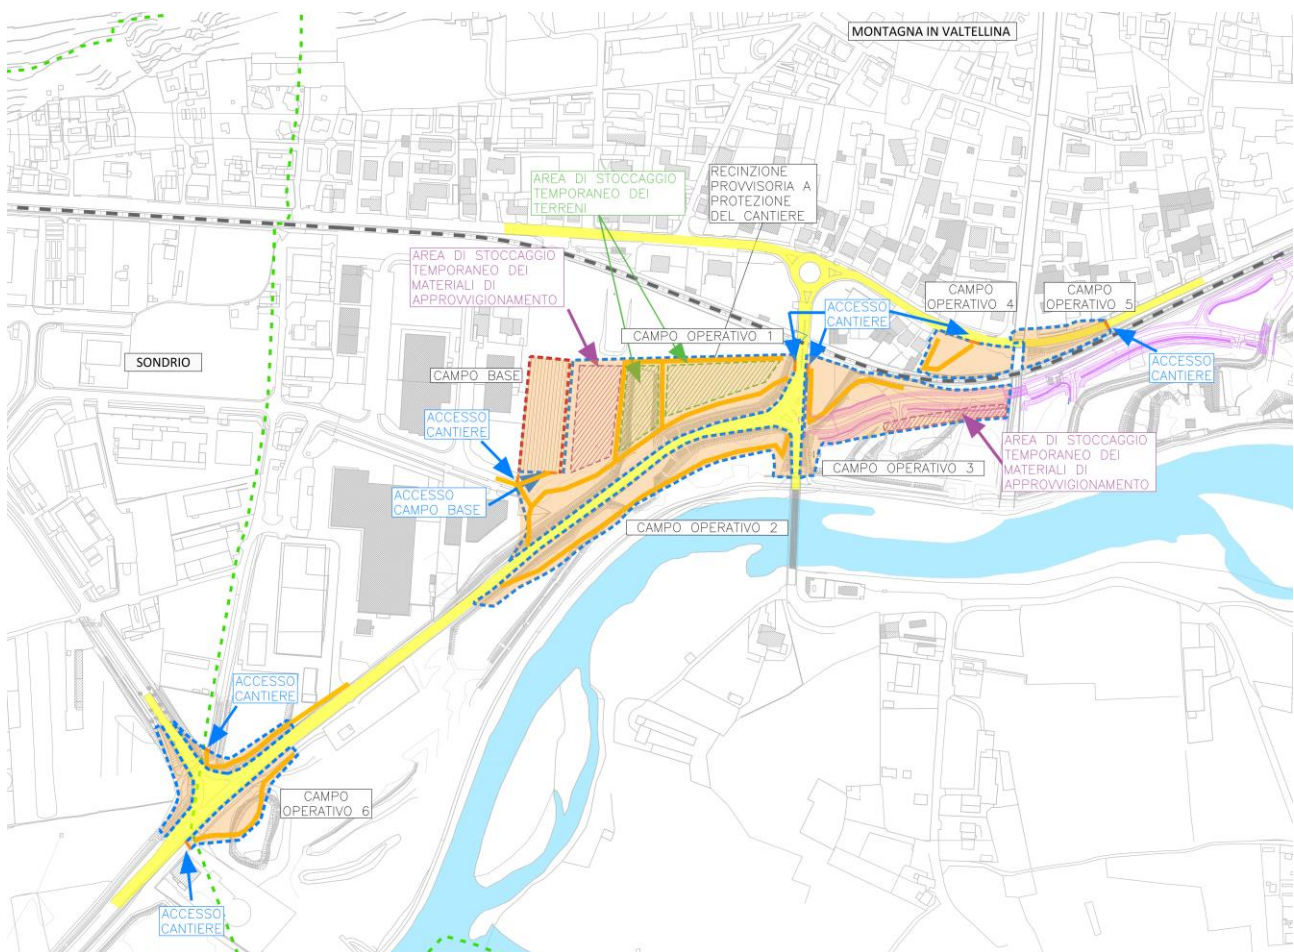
Estratto planimetria ubicazione delle aree di cantiere e relativi accessi
